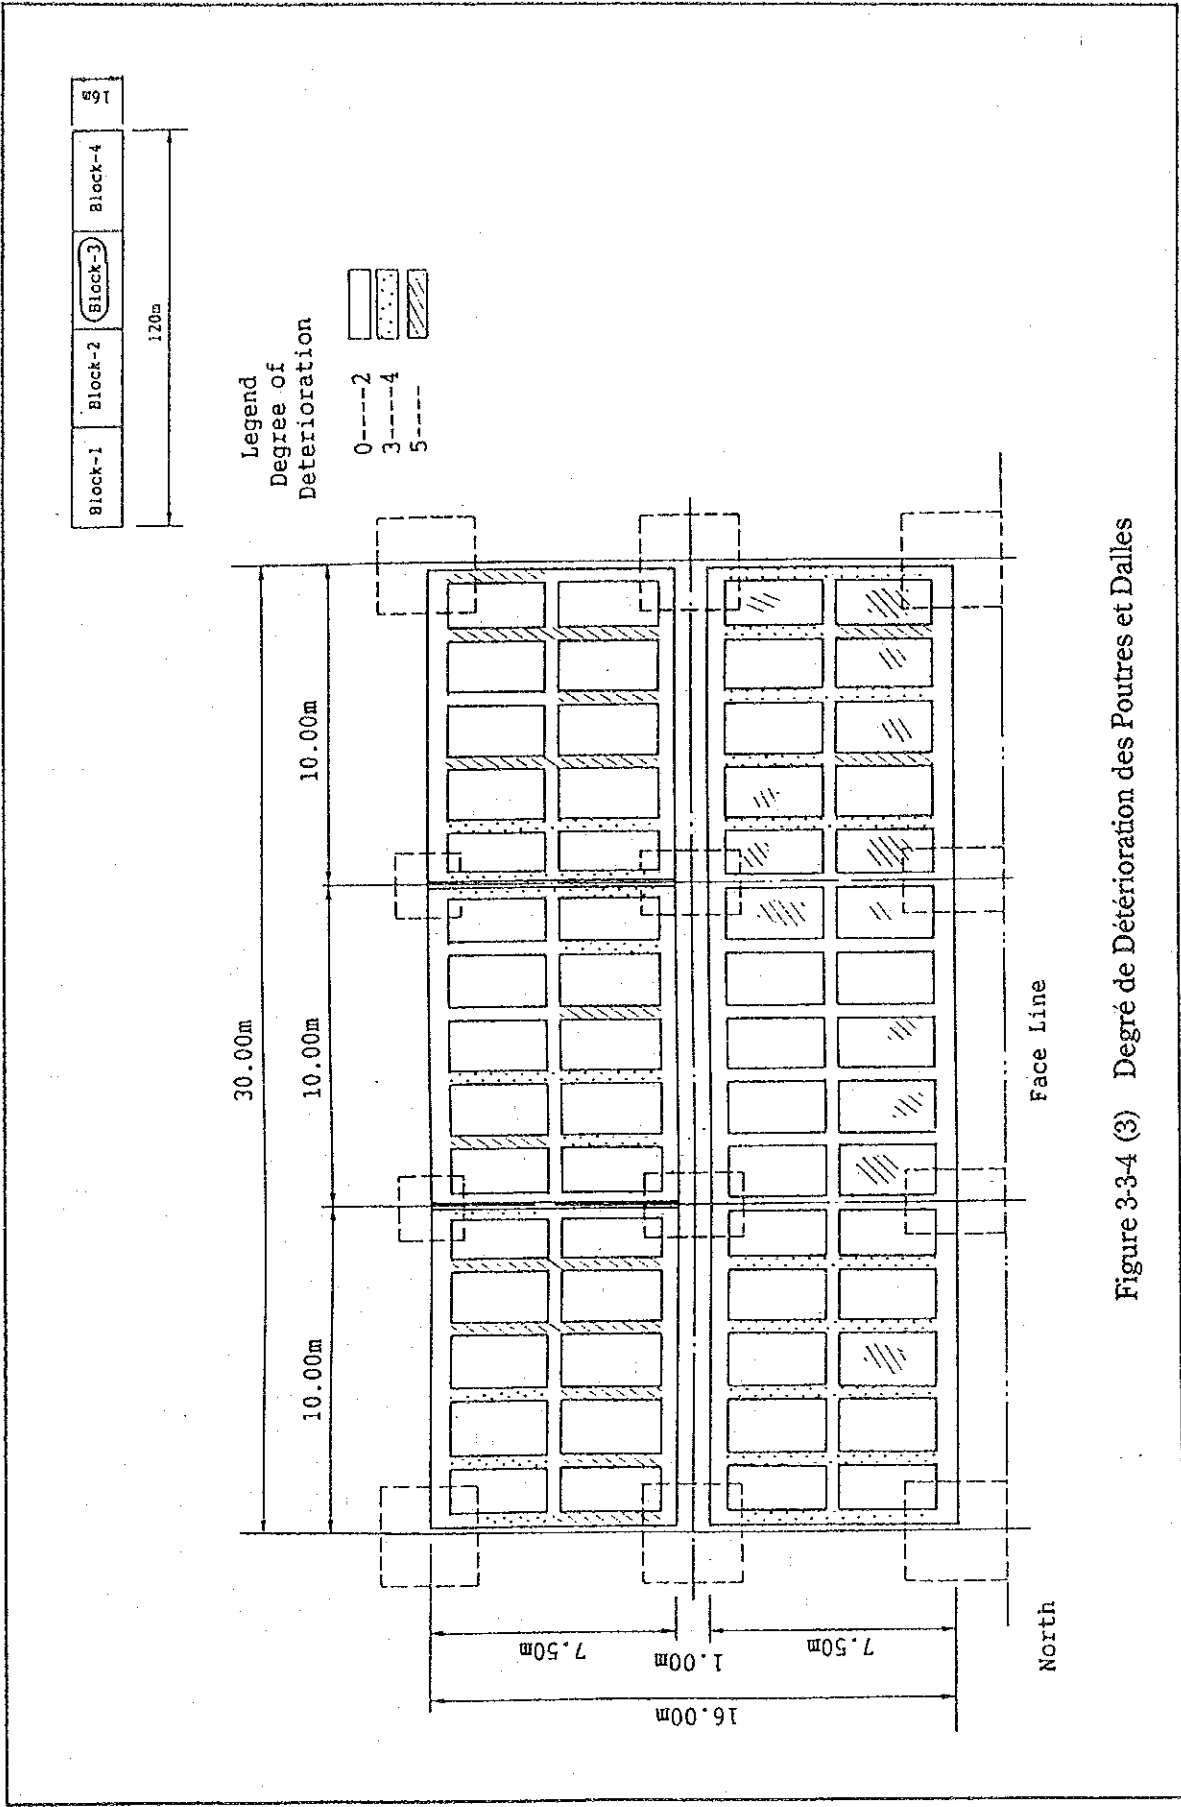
(3) Degré de Détérioration des Poutres et Dalles
